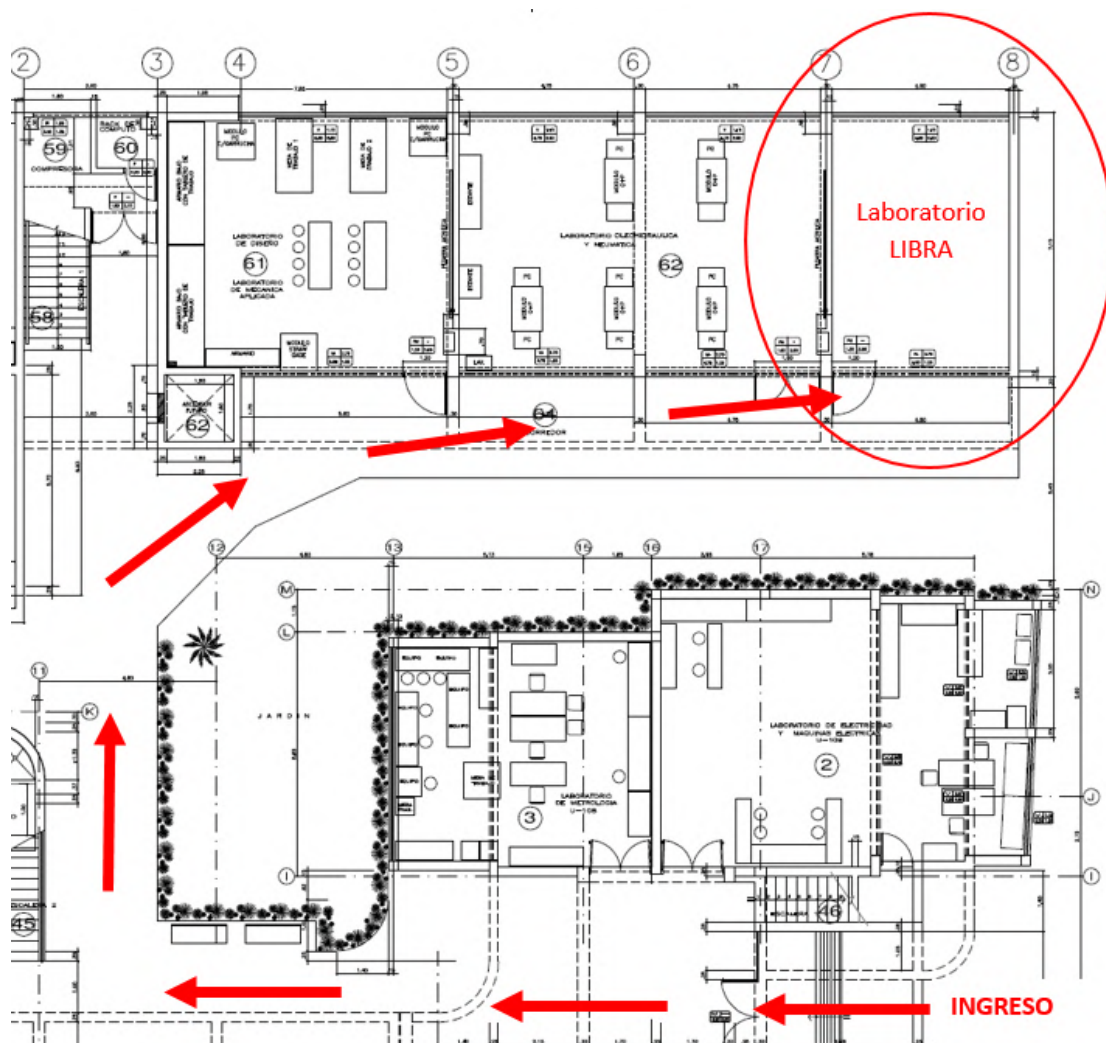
Plano de ruta de ingreso al Laboratorio LIBRA en la Sección de Ingeniería Mecánica
